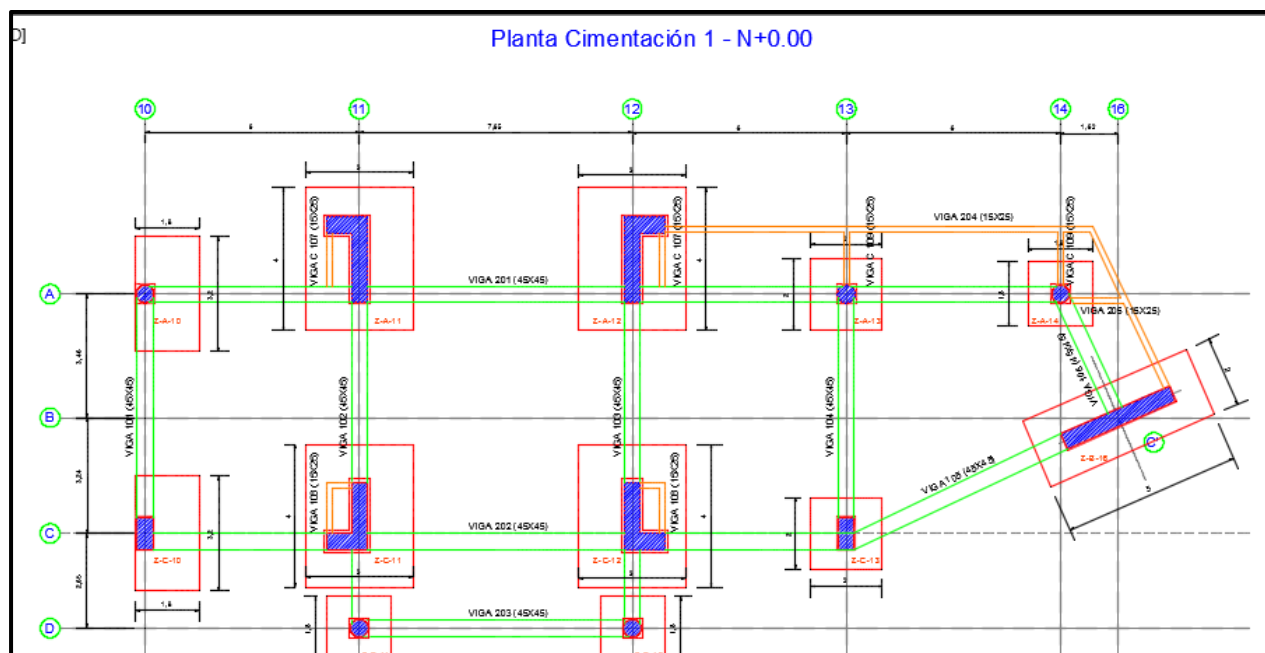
Planta de cimentación, zona en ejecución del proyecto.
